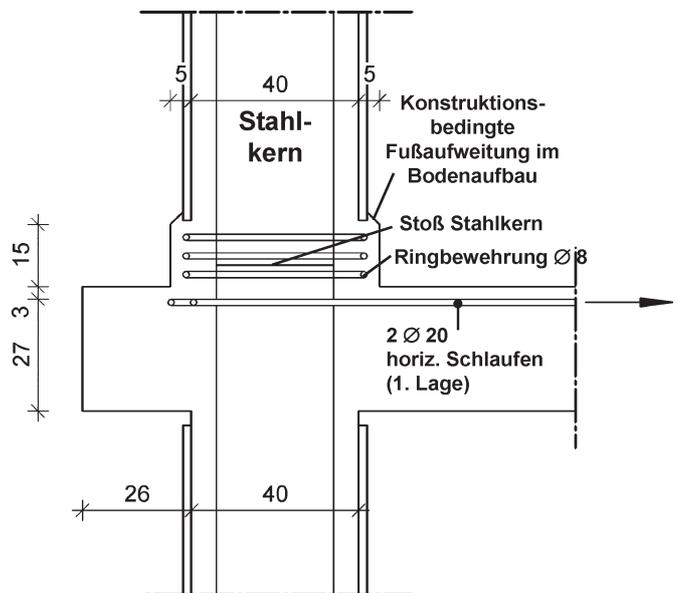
Konstruktionsbedingte Aufweitung im Bodenaufbau
